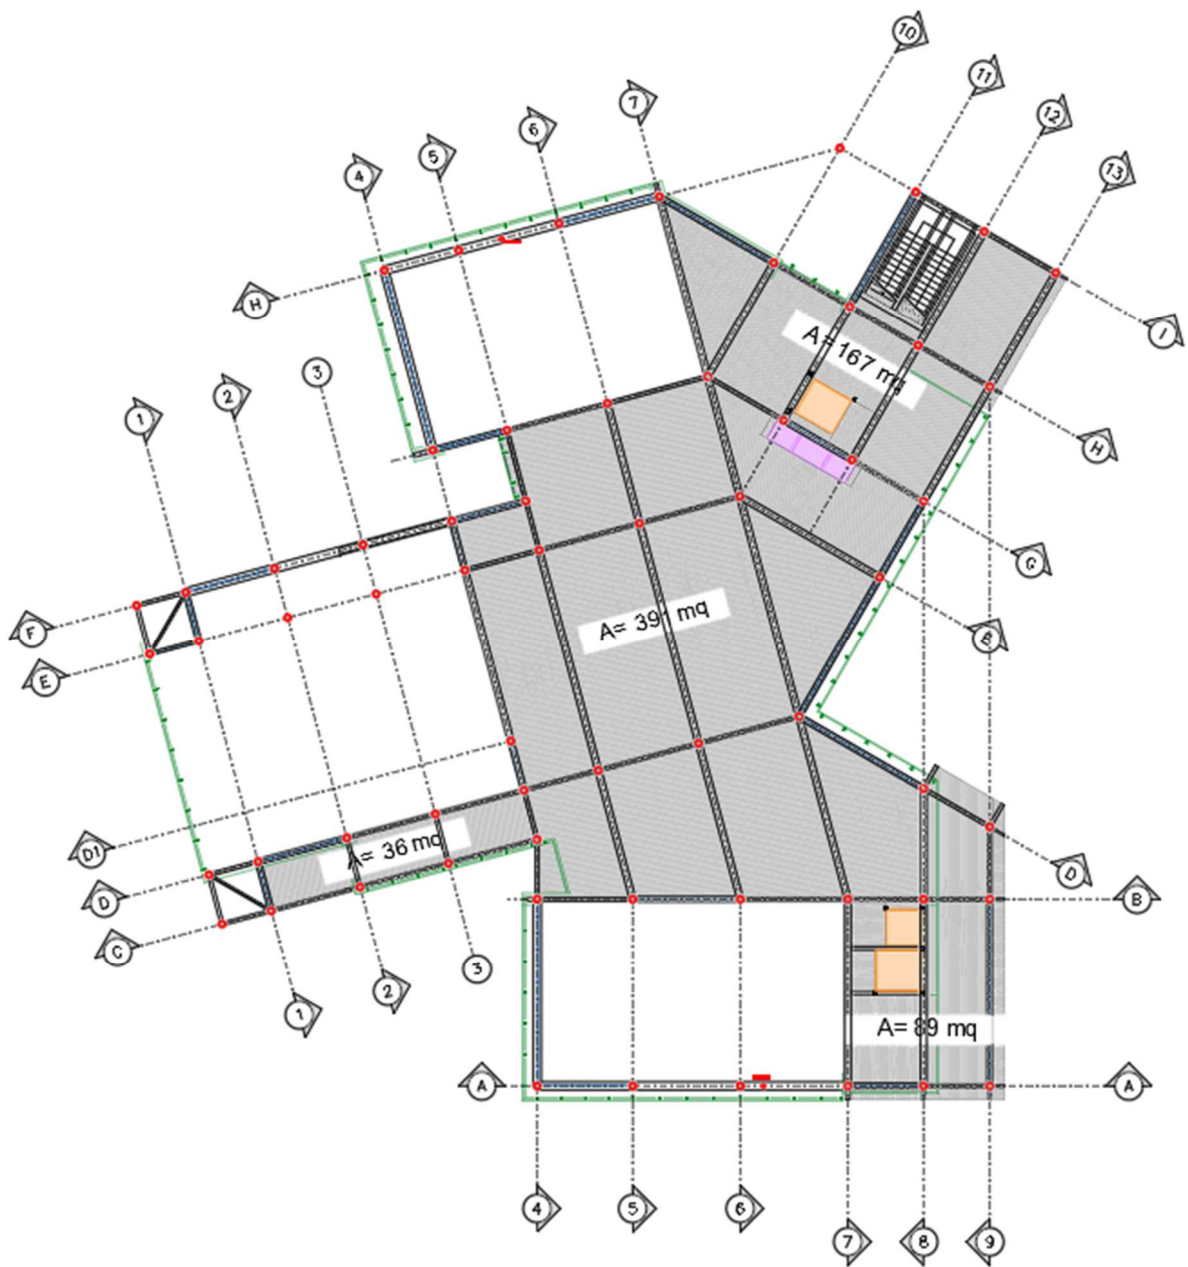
Piano q=+7,700 m: calcolo aree solaio con lamiera grecata
